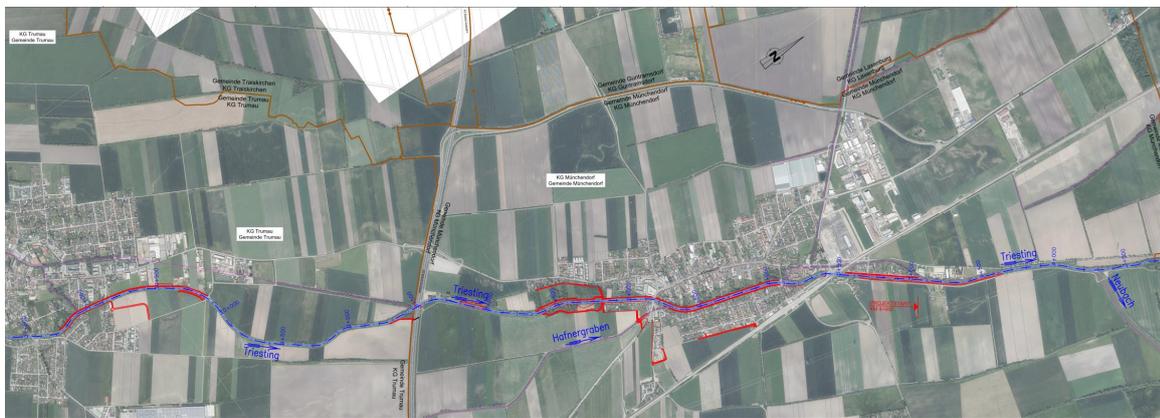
Übersichtslageplan Trumau – Münchendorf, Bezirk Baden und Mödling
